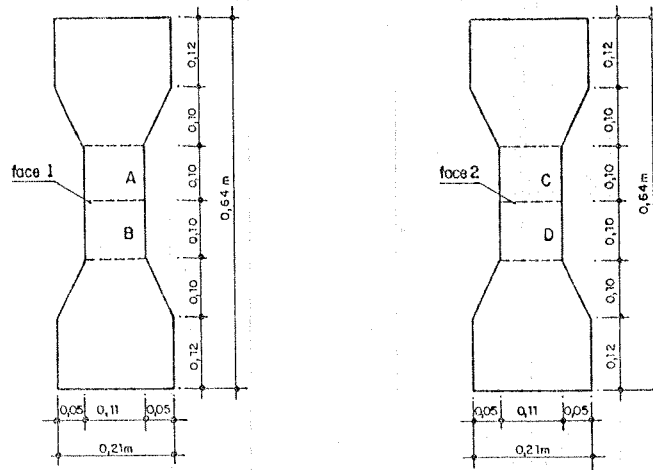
Regiões de observação da abertura de fissuras nos ensaios de tração. Em cada uma das faces, a faixa de observação de 20 cm foi dividida em duas regiões de 10 cm. As regiões A e B correspondem à face 1 e as regiões C e D, à face 2. O espaçamento entre fissuras foi acompanhado junto às linhas médias da largura, nas duas faces, conforme acusado na figura.
